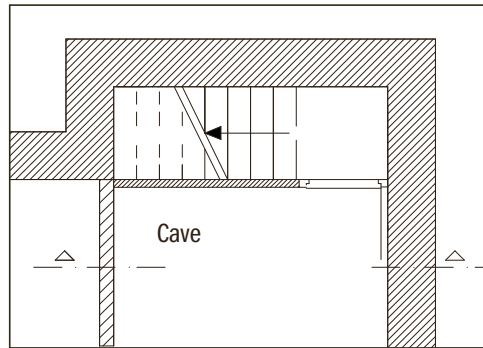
Plan d'un accès à la cave (source : SMUL).
